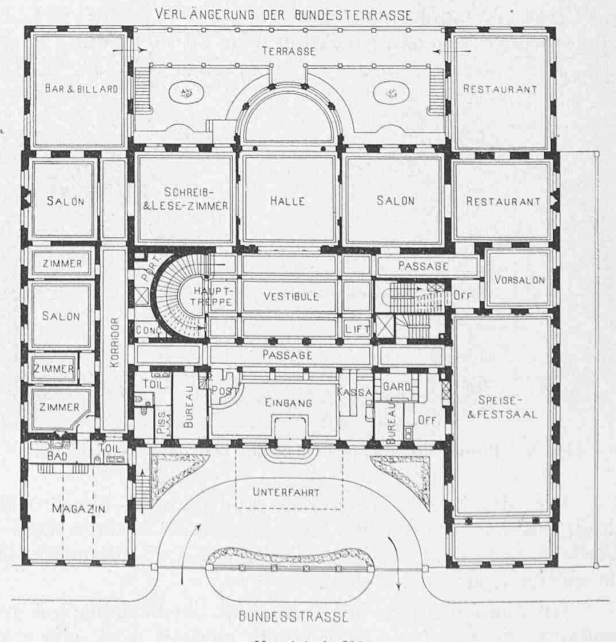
Erdgeschoss-Grundriss vor dem Umbau.
